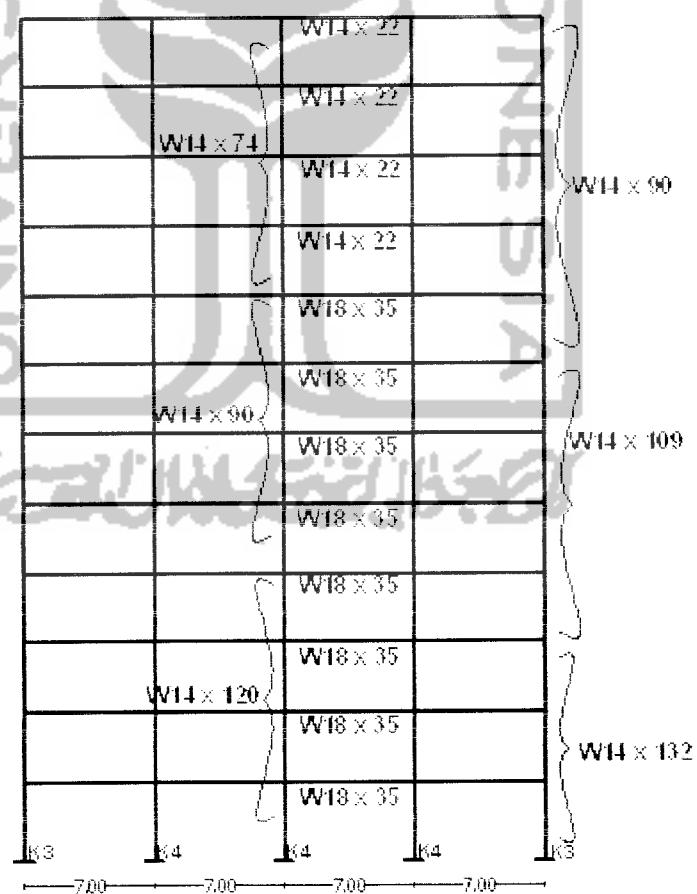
Denah Struktur Dengan Menggunakan Kolom Baja Murni
